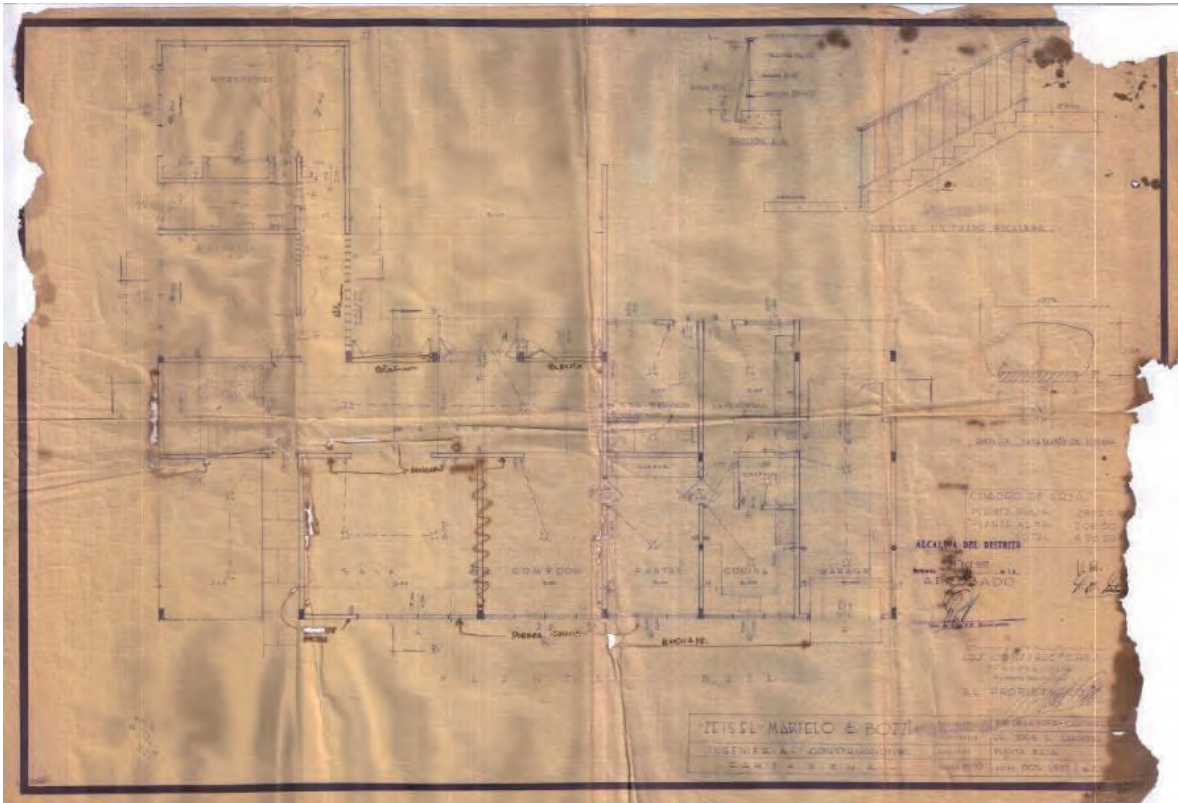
Plano primera planta casa Dr. José Cabrera. Distribución tipológica en “L”. Fuente: Archivo arquitecto Gregorio Cabrera García. 1957.
